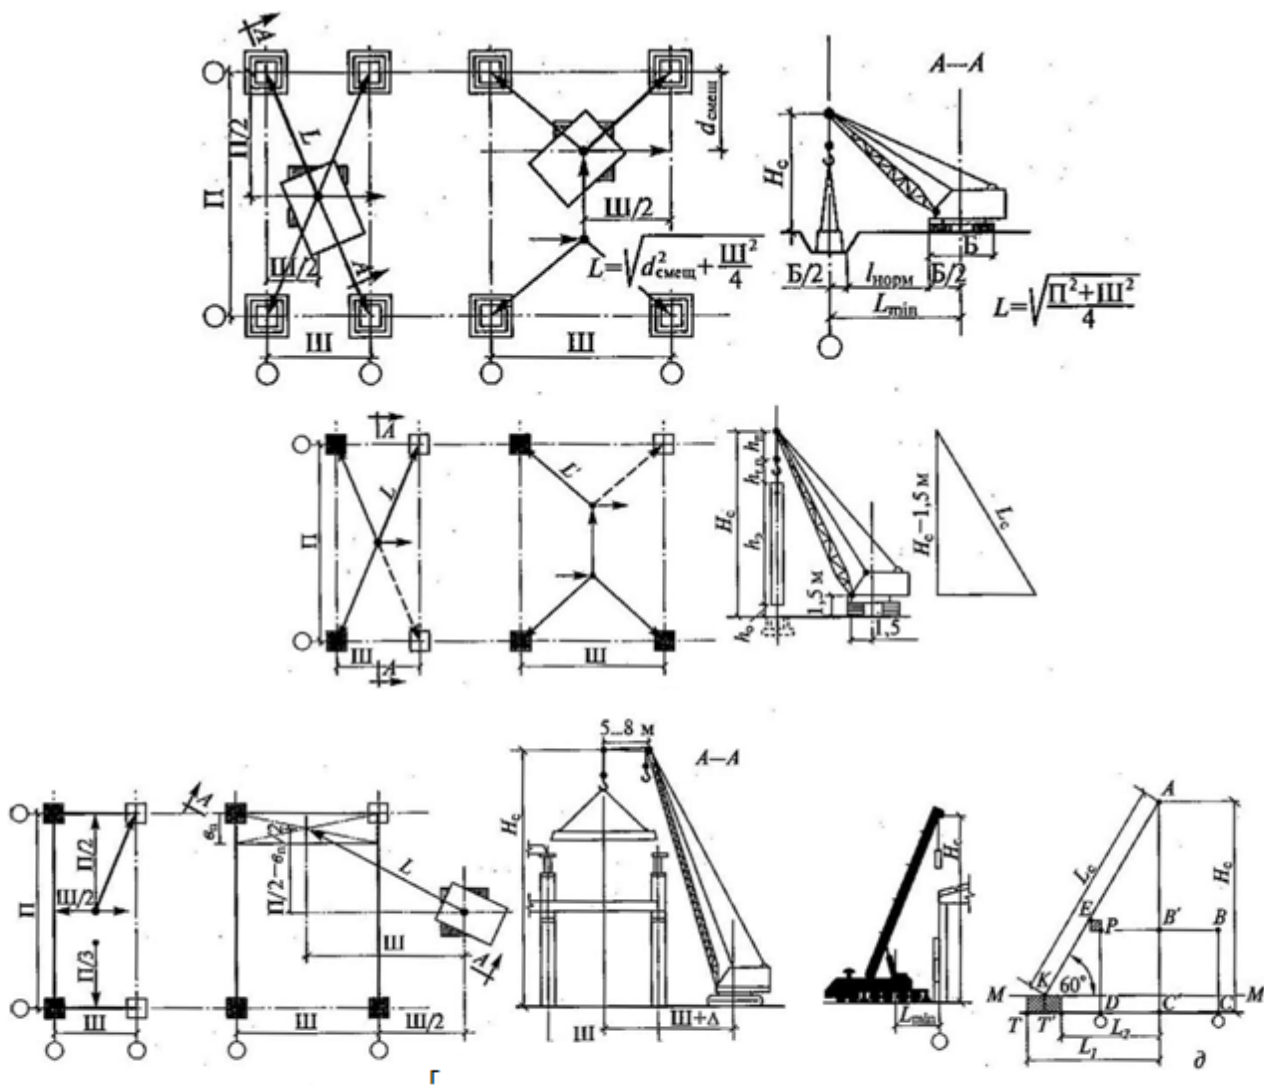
Определение основных характеристик крана графическим методом при монтаже: а - фундаментов; б — колонн; в- ферм, подкрановых балок и плит покрытия; г - стеновых панелей; д - упрощенный способ; ш- шаг; П — величина пролёта; $d_{\text{смещ.}}$ - длина смещения крана; $l_{\text{норм.}}$ - расстояние от опоры до бровки.
